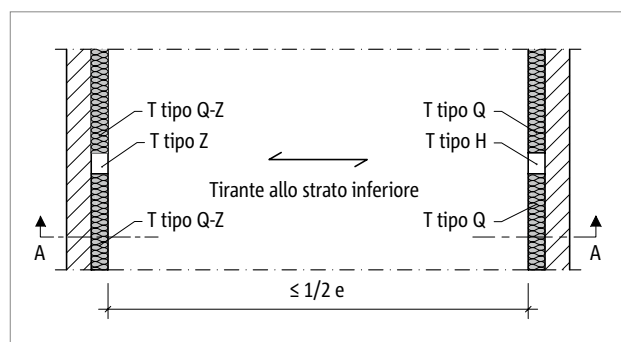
Schöck Isokorb® T tipo Q-Z, Q-Z: soletta in calcestruzzo armato monodirezionale
